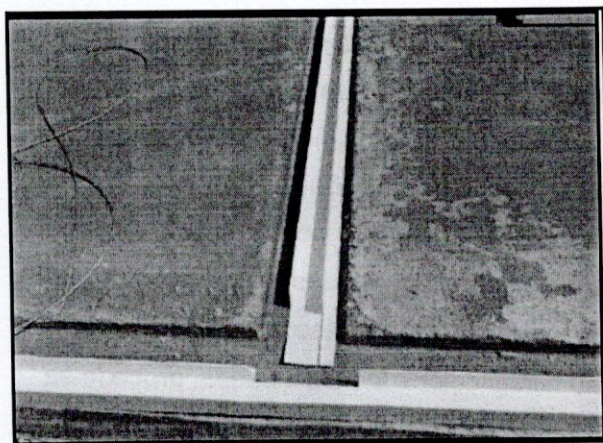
Perfil em PVC para fixação parede com a fundação.
